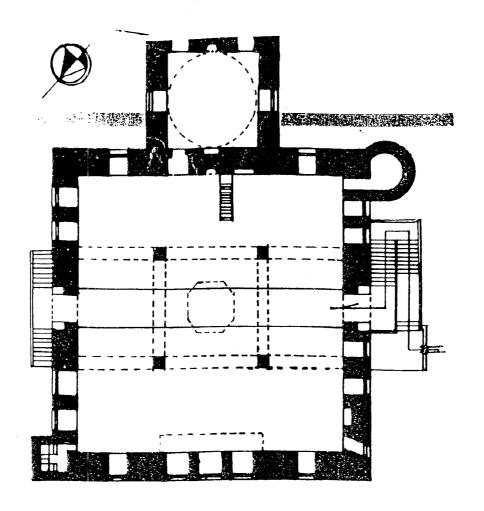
مسقط أفقى لجامع داود باشا بسويقة اللالا ٩٥٥ _ ٩٦١ هـ / ١٥٤٨ ـ مكل (٢) مسقط أفقى لجامع داود باشا بسويقة الآثار المصرية).
